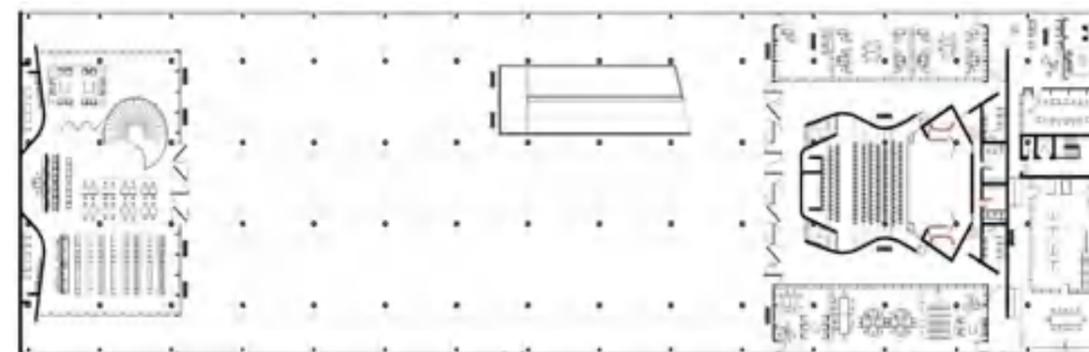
Planta Baixa Pavimento Superior. Fonte: Brasil Arquitetura.
